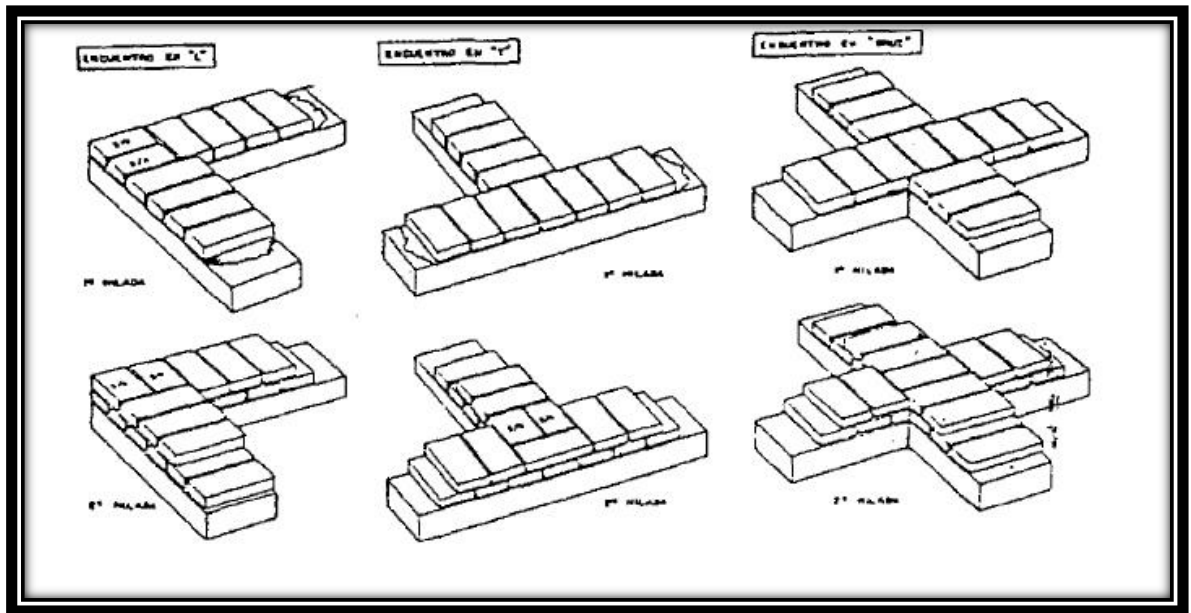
Tipos de amarre para adobes rectangulares.
